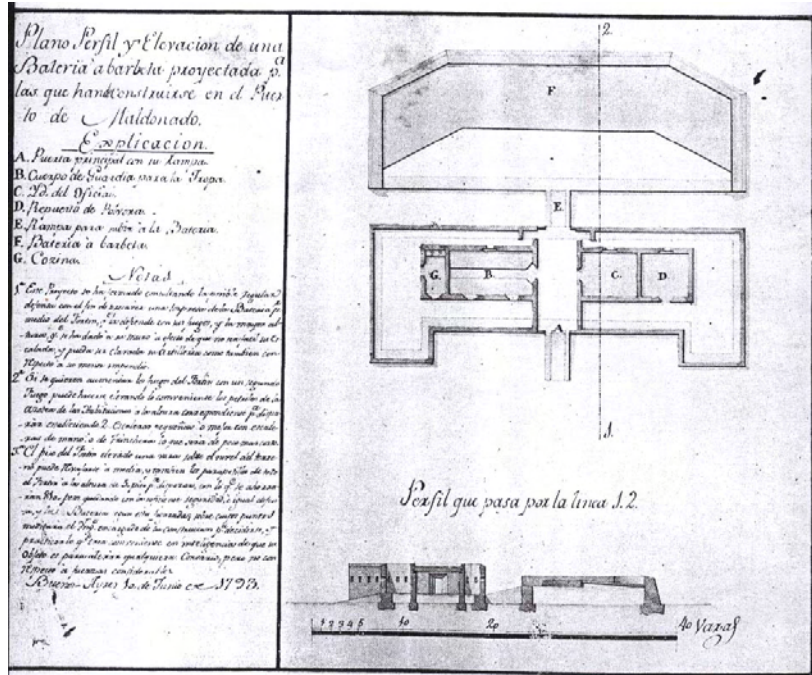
Planta: Bateria sem merlões para o porto de Maldonado (1793)
